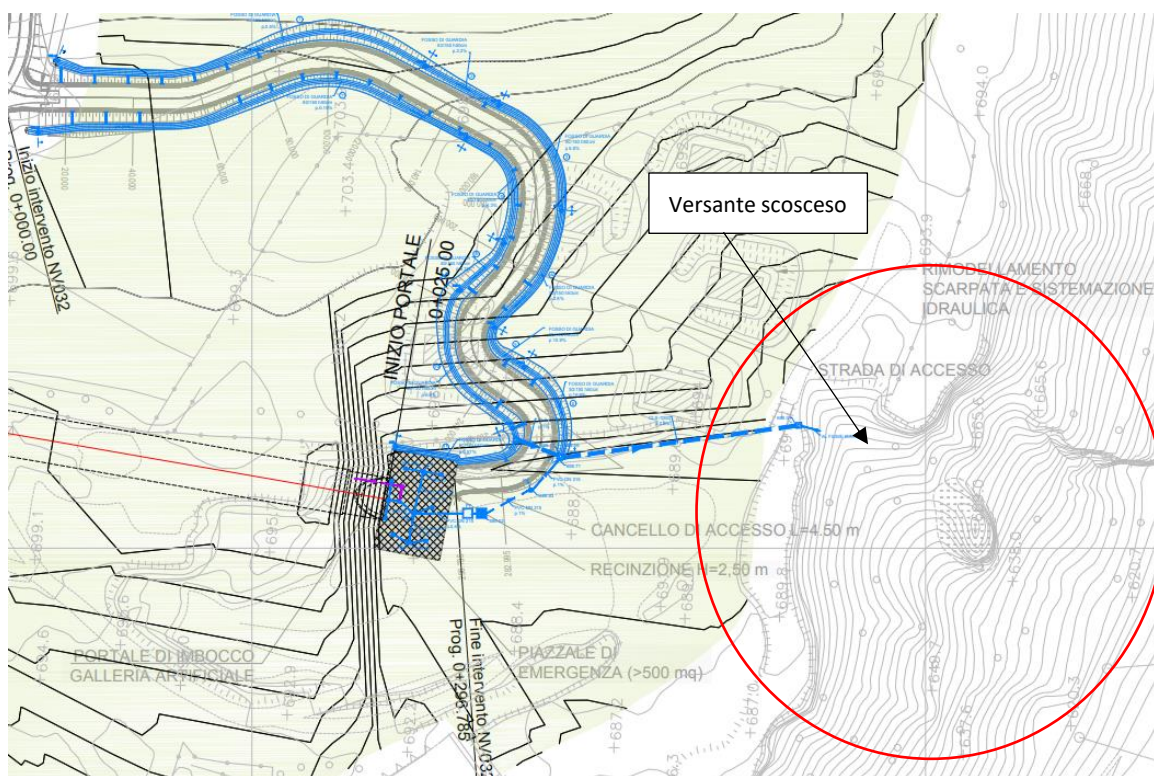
Planimetria idraulica NV032 con recapito sul versante (PD)
